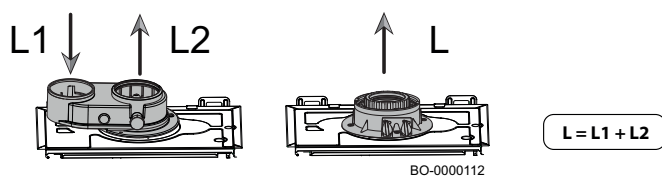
Afzonderlijke voorbeelden leidingsinstallatie
